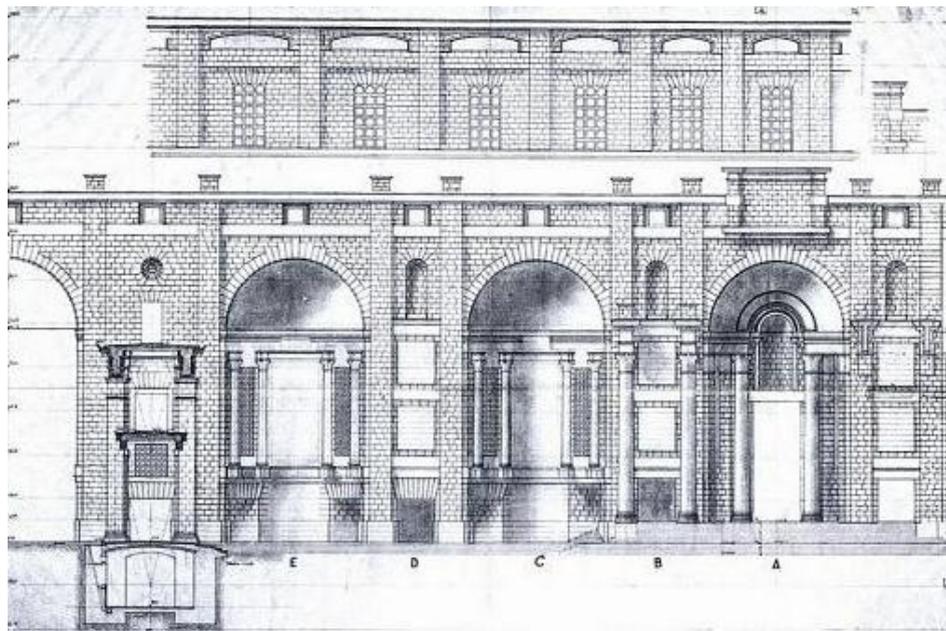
Plano del Proyecto Original en el que se desarrolla el alzado exterior de la iglesia.
